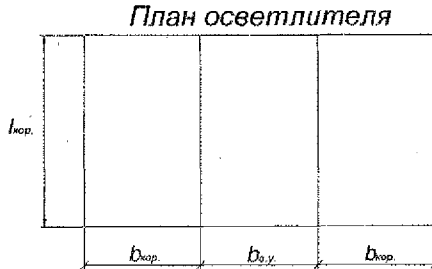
а – План осветлителя со слоем взвешенного осадка
